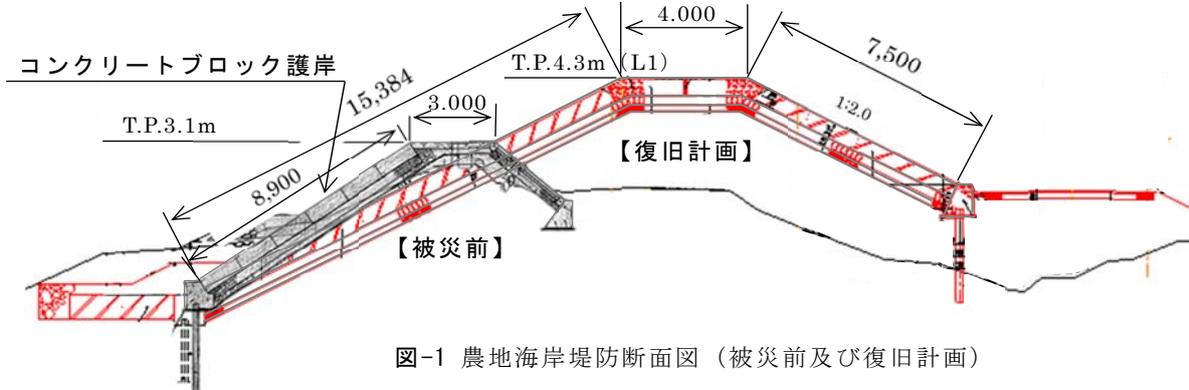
農地海岸堤防断面図 (被災前及び復旧計画)
